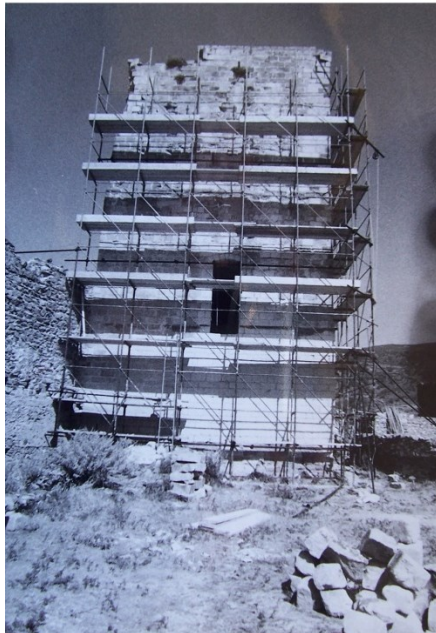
Foto del cantiere di restauro degli anni 1967-70 del castello di Burgos (ASBAPSS)
